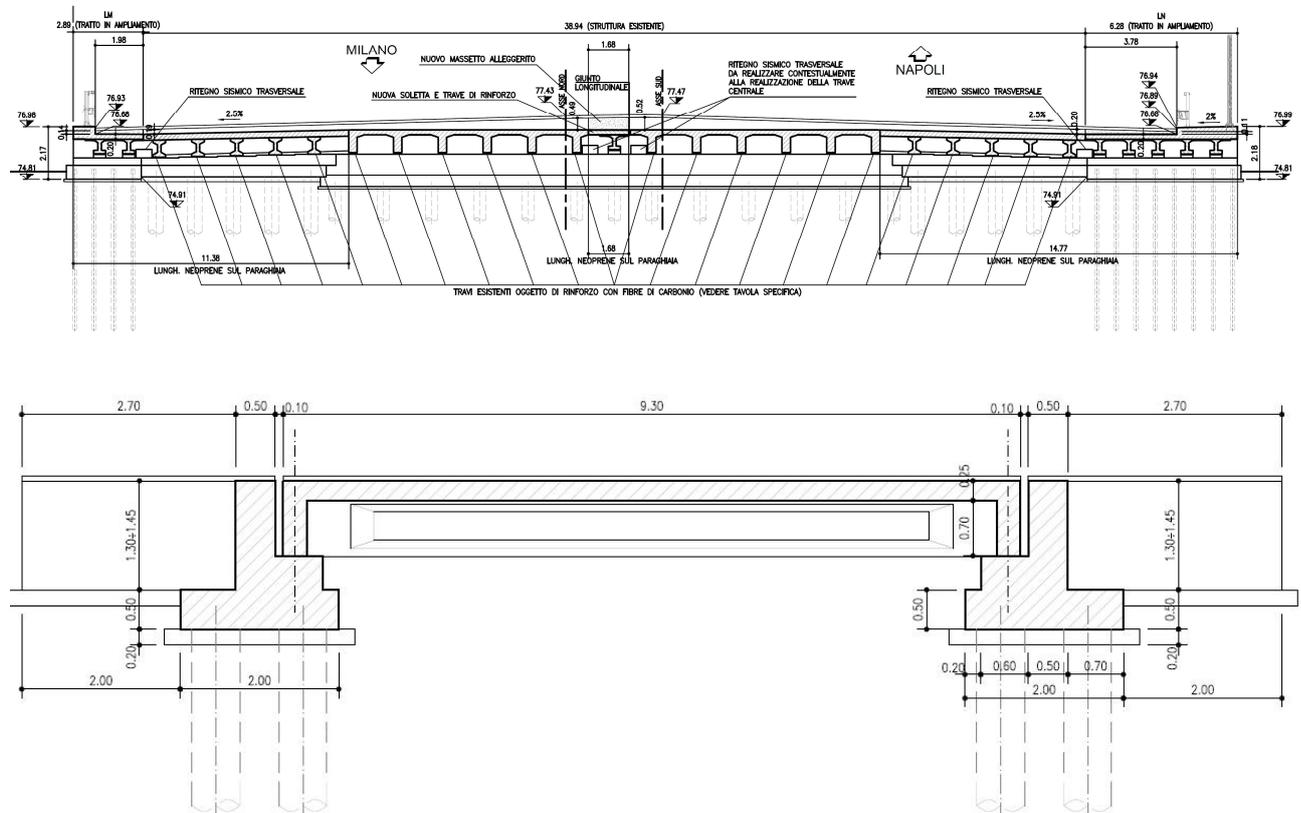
Ponte Sillaro 2 - Sezione trasversale e longitudinale
